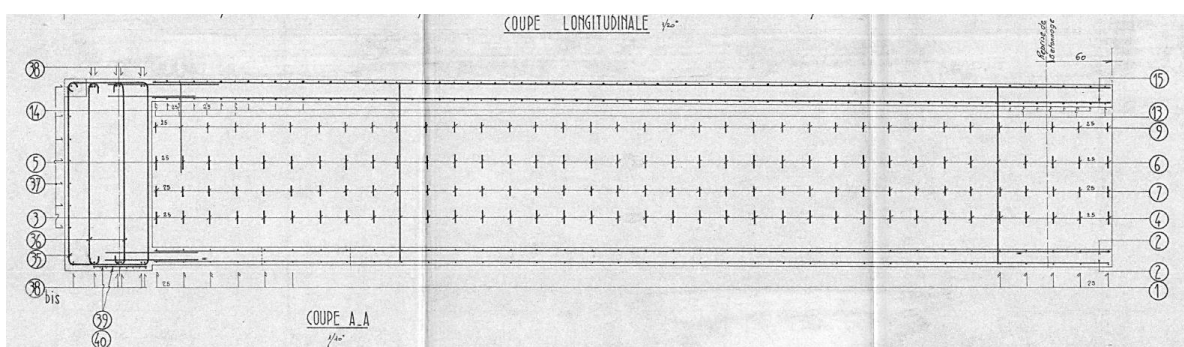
Extrait de plan de ferrailage de l'about – Élévation
